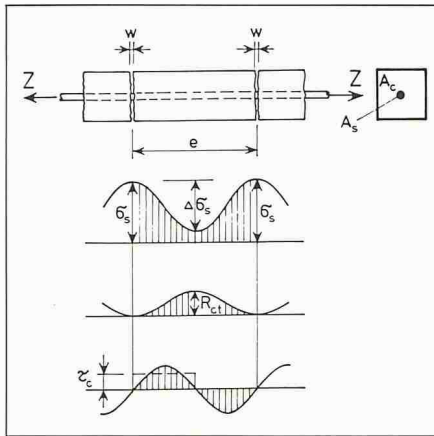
Spannungen im gerissenen Stahlbetonzugglied (nach [2]): a) Abmessungen; b) Stahlzugspannung; c) Betonzugspannung; d) Verbundspannung
